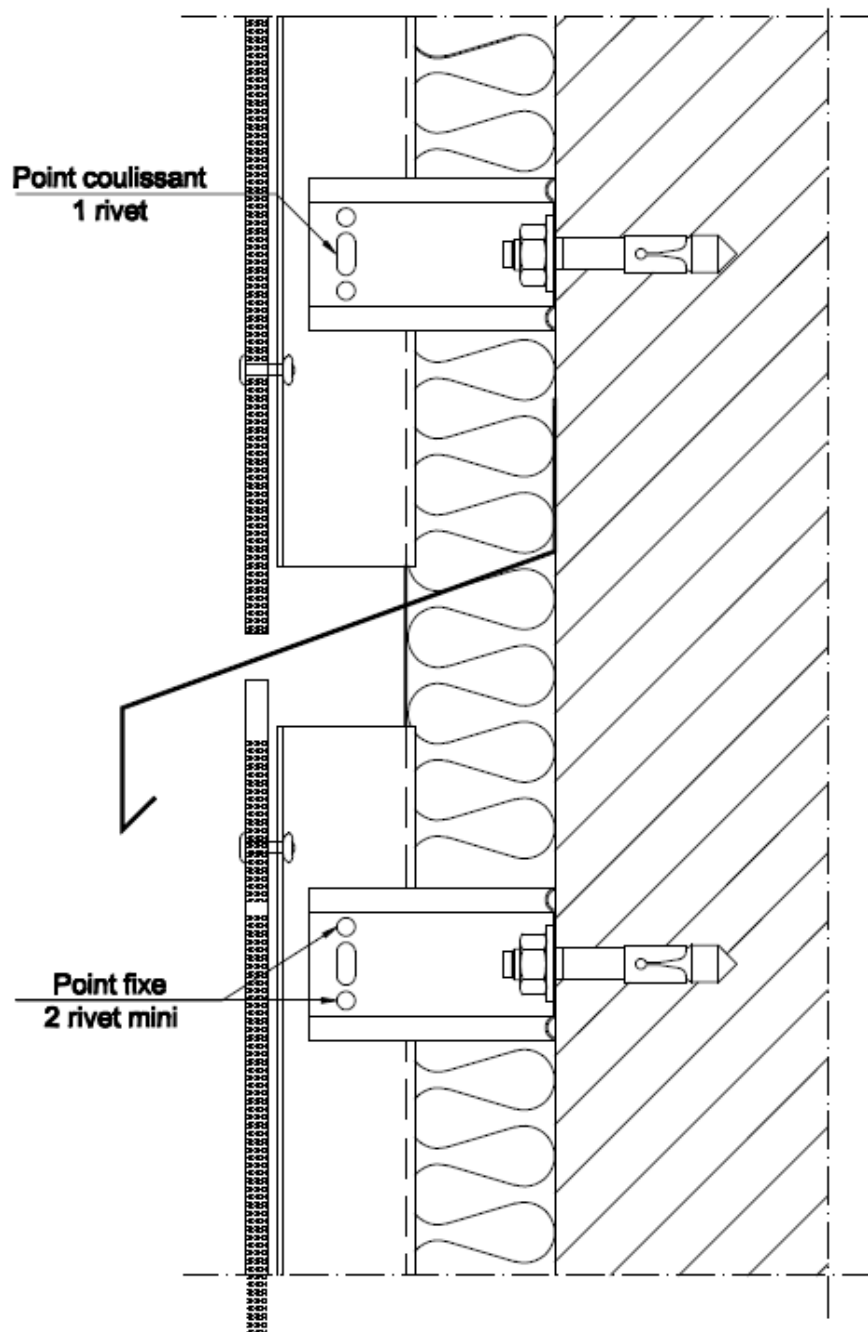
Coupe verticale sur joint horizontal (recoupement de la lame d'air)
